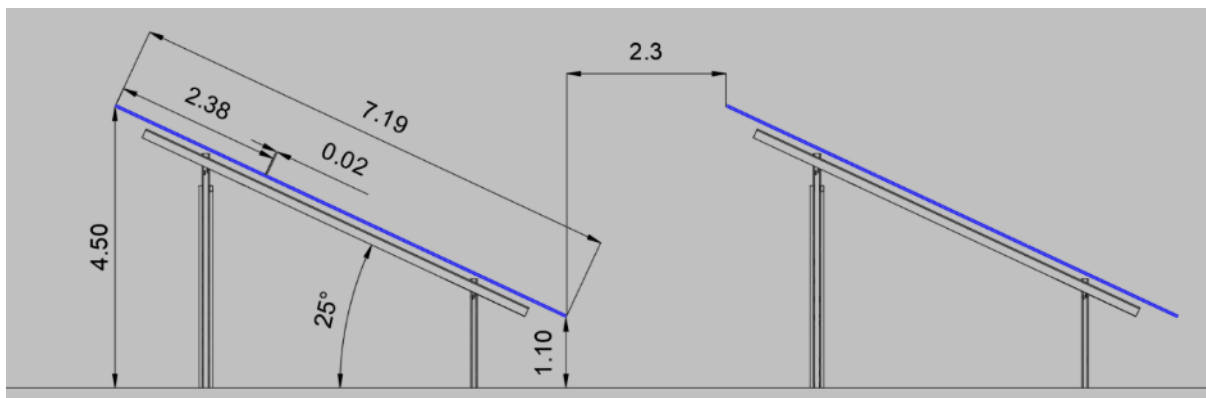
Schéma de coupe d'une rangée (Source : TSE)
